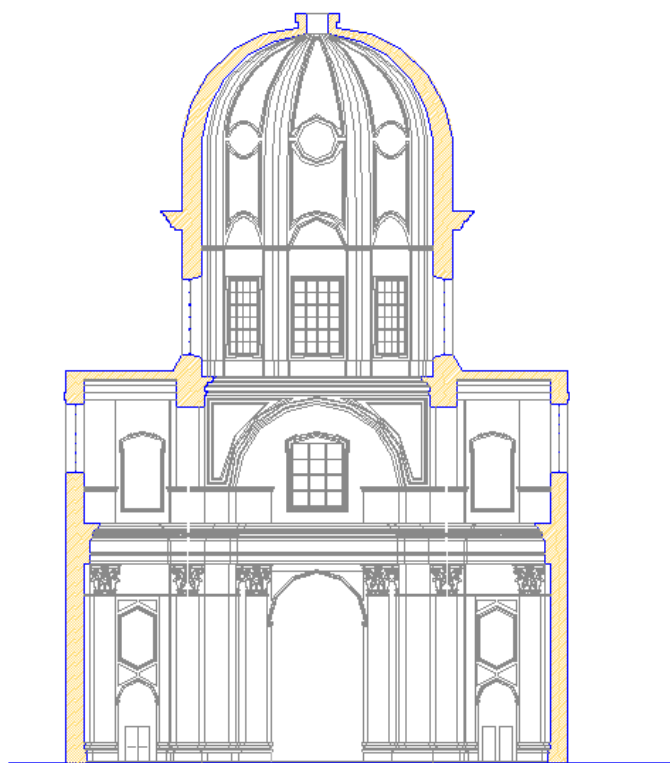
Santa Maria Maggiore della Pietrasanta. La Sezione trasversale.
